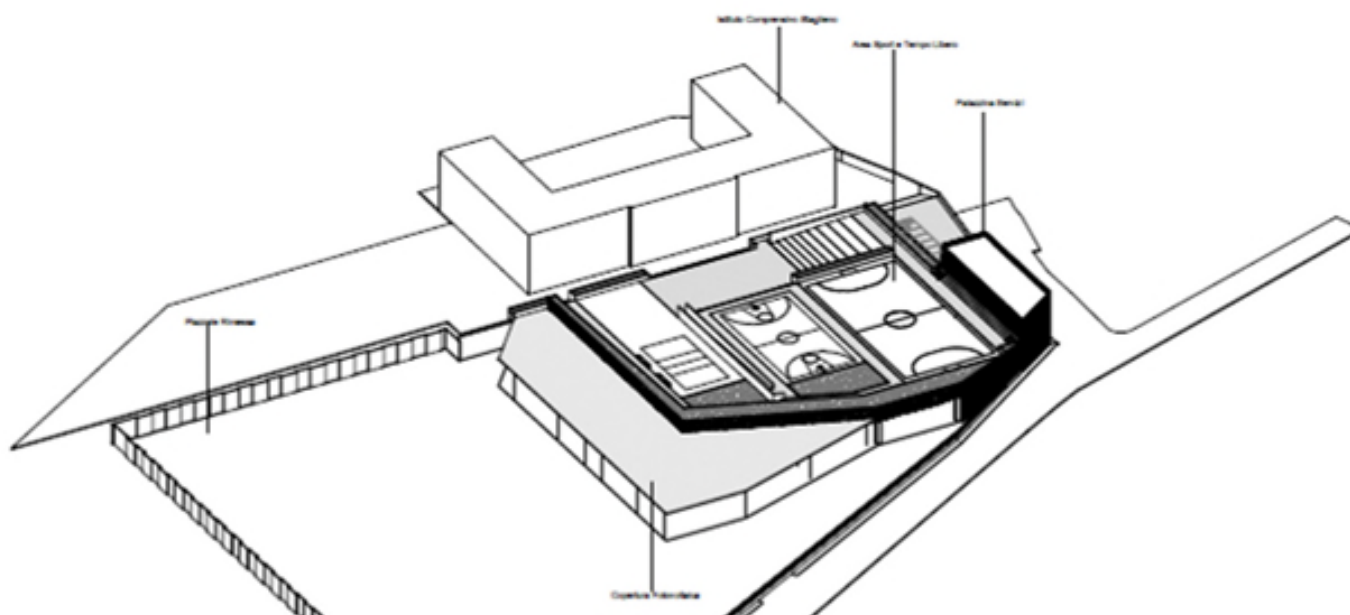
Vista assometrica della Rimessa Gavette
